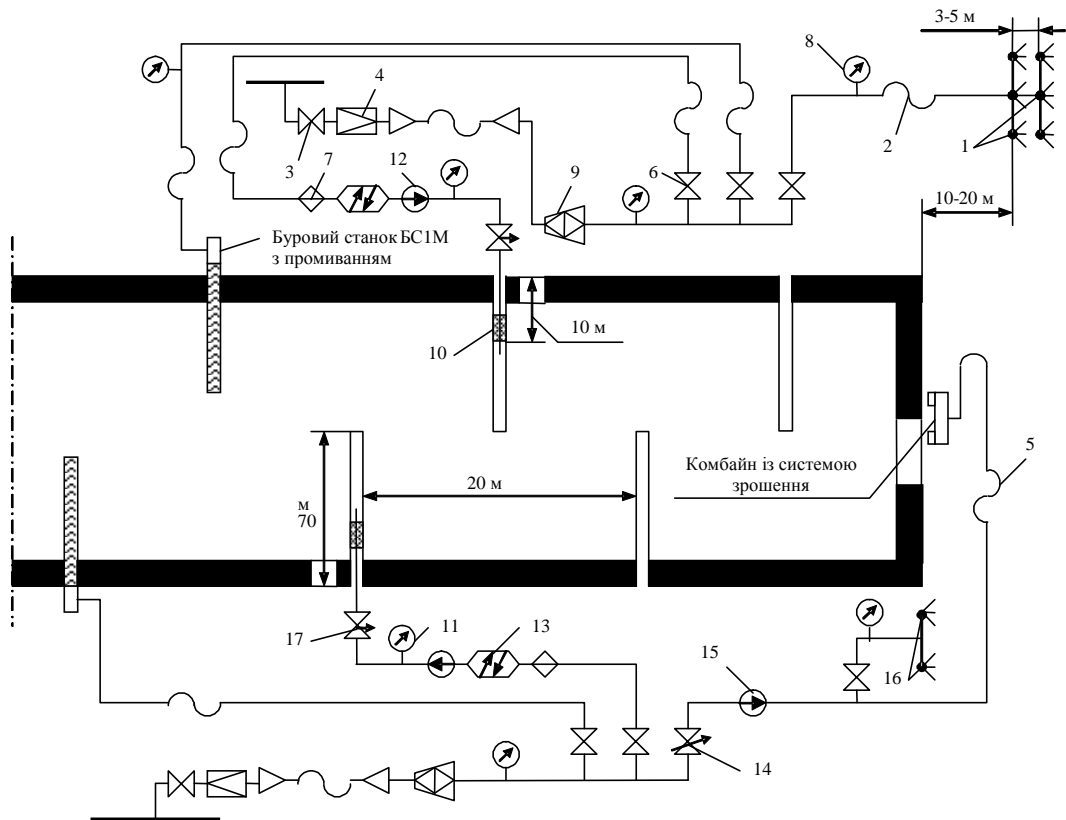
Схема розташування обладнання для обезпилення ділянки
